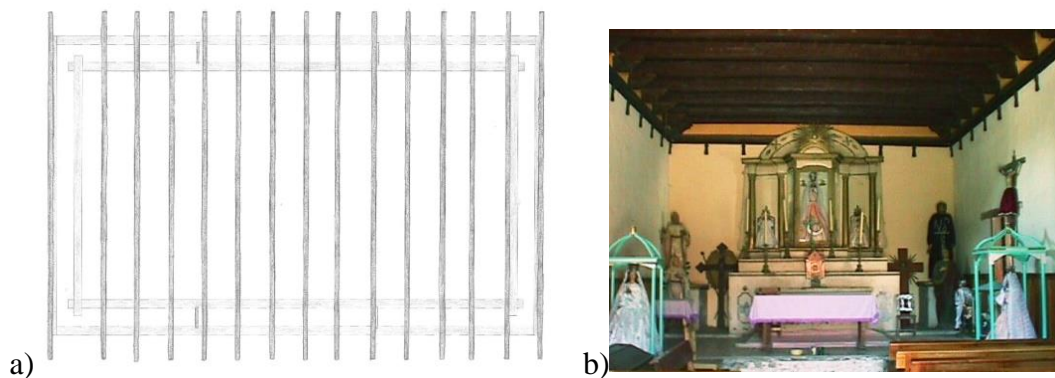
a) Planta del sistema de vigas y b) Plafón del interior de la capilla.
